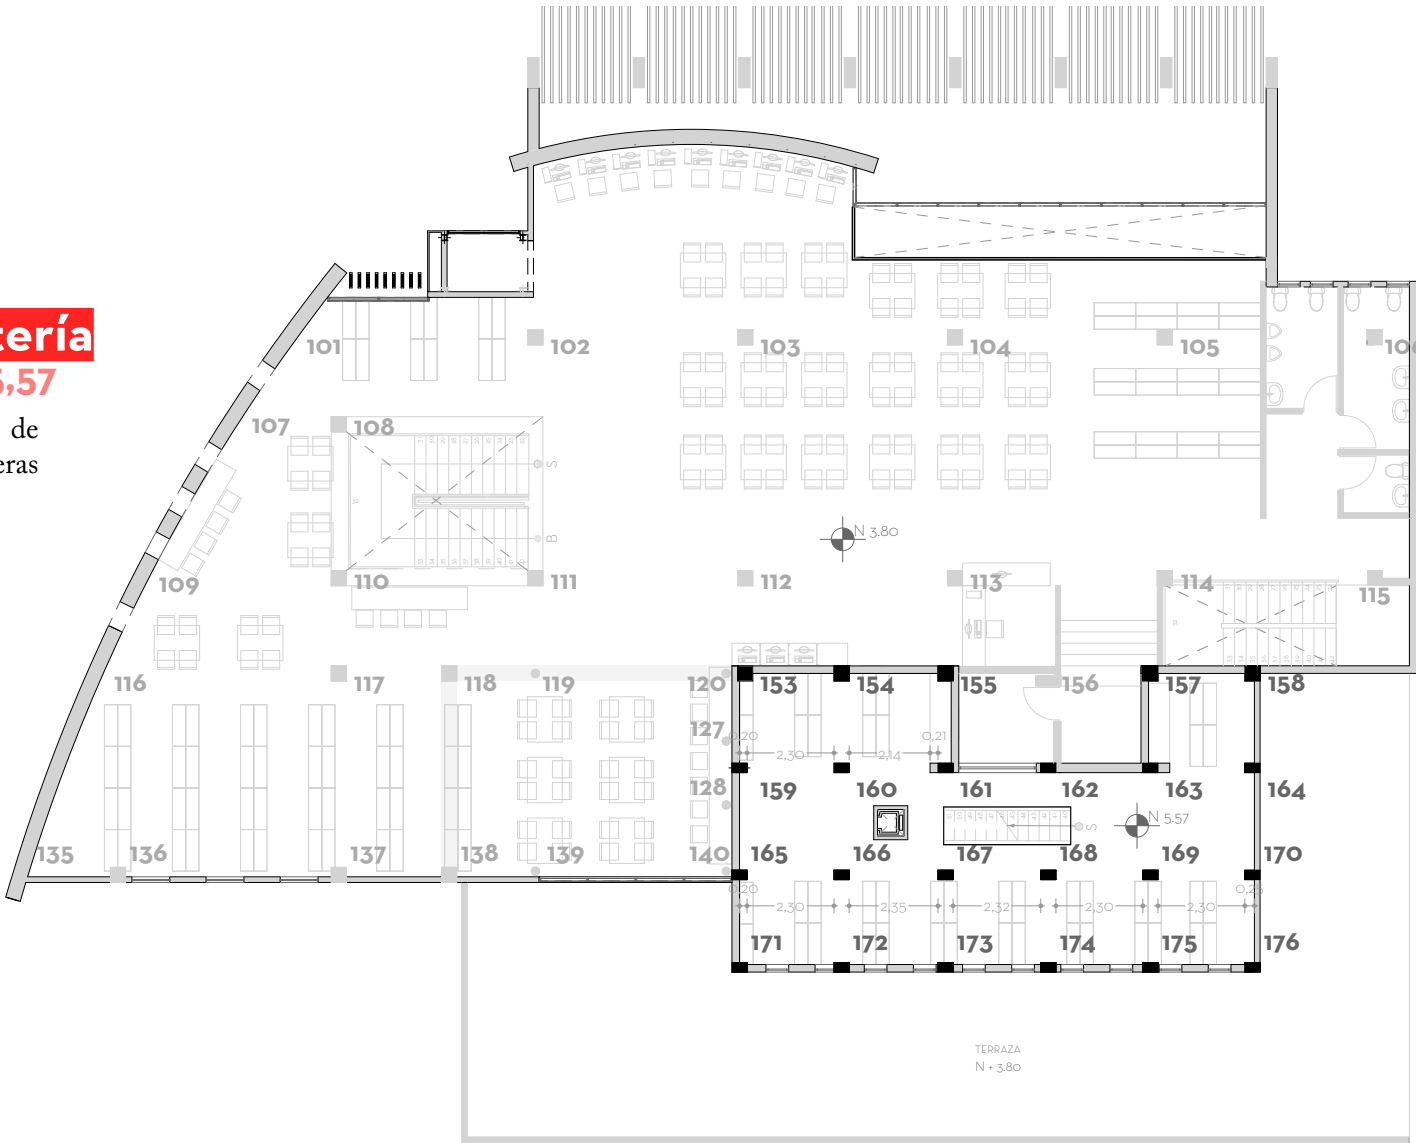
Primera Planta Alta - Nivel +3.80 + Estantería - Nivel +5.57. Planos actualizados de la edificación del Centro de Documentación Regional Juan Bautista Vásquez. Levantamiento arquitectónico y digitalización realizada por Morochó & Sarmiento (2020).
